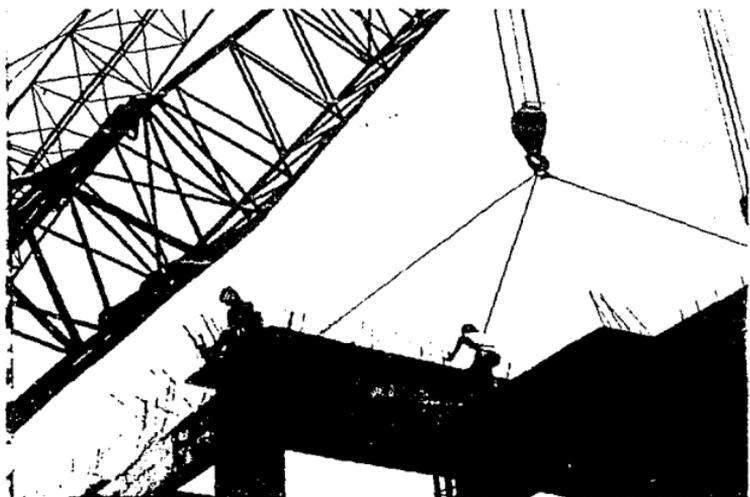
MONTAJE DE LOSAS PREFABRICADAS, SE APRECIA LA PREPARACION EN TRABES PARA LA COLOCACION DE LOS ESTRIBOS.
